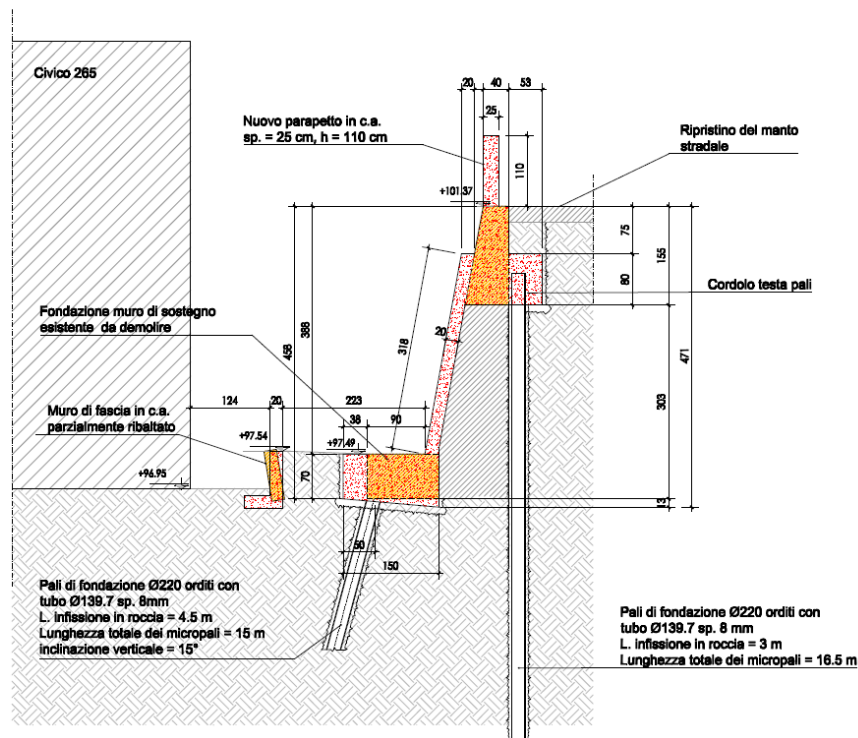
Sezione raffronto intervento Lotto 2 – Fase 2
